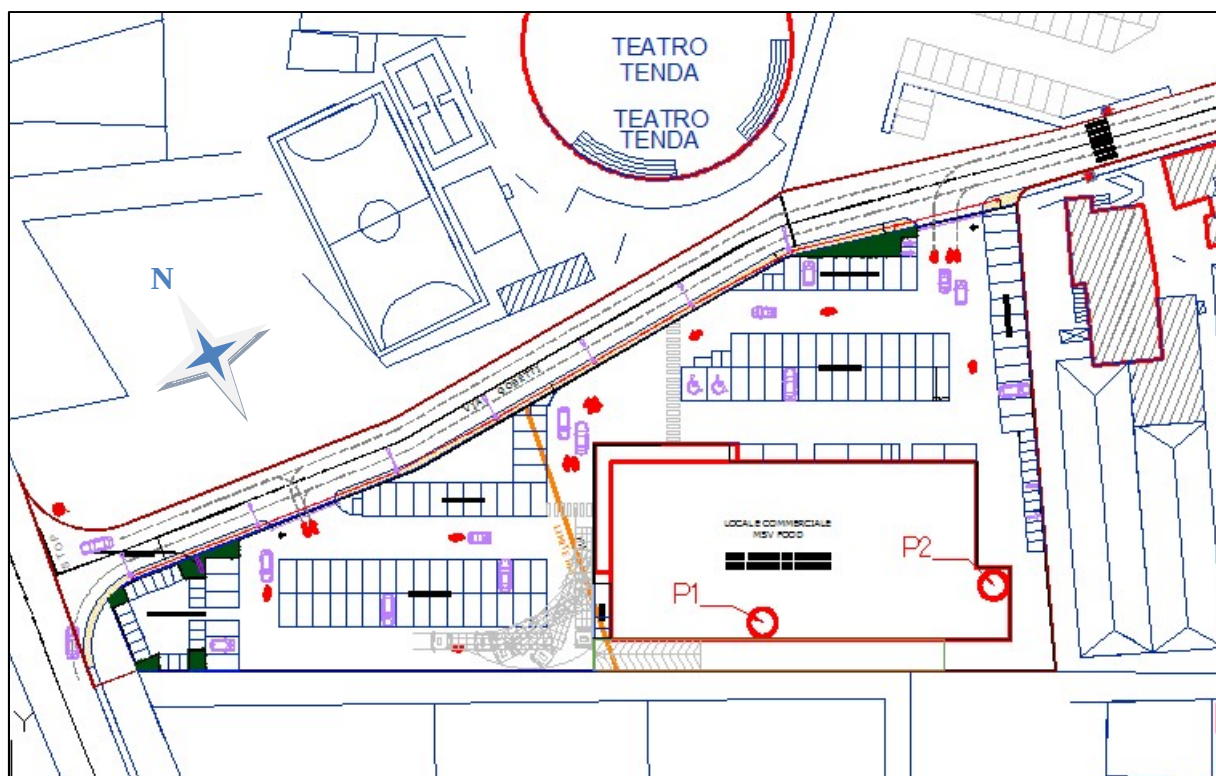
planimetria di progetto ed ubicazione pozzetti esplorativi.
